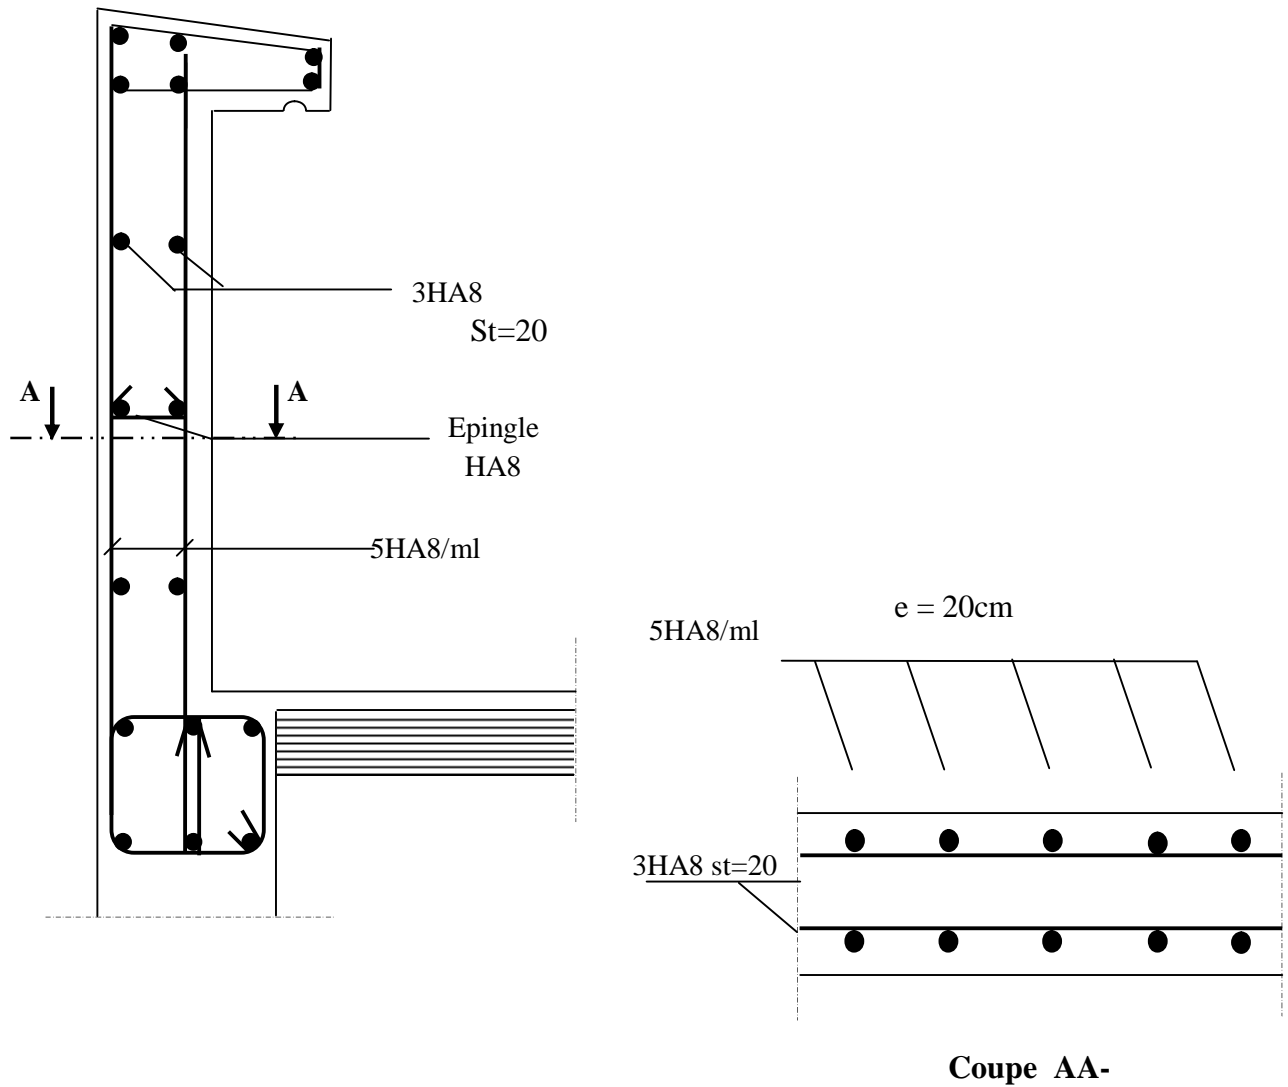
Plan de Ferrailage de l'acrotère.
